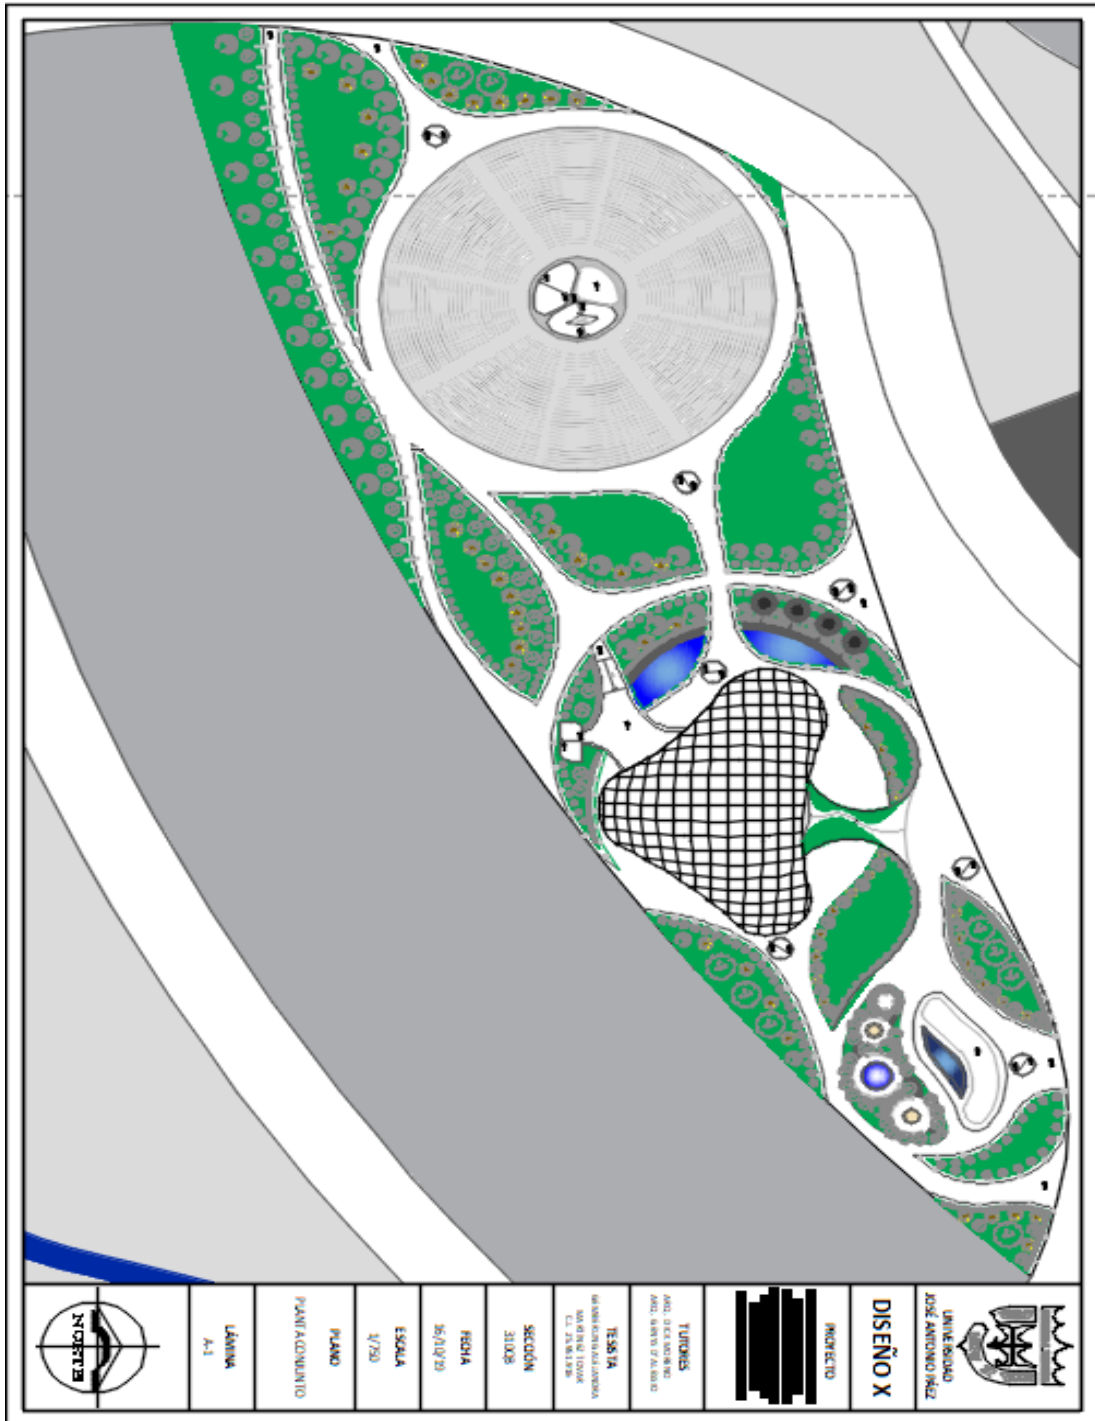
Planta Conjunto. Autor: Gemberling Martínez (2018)
